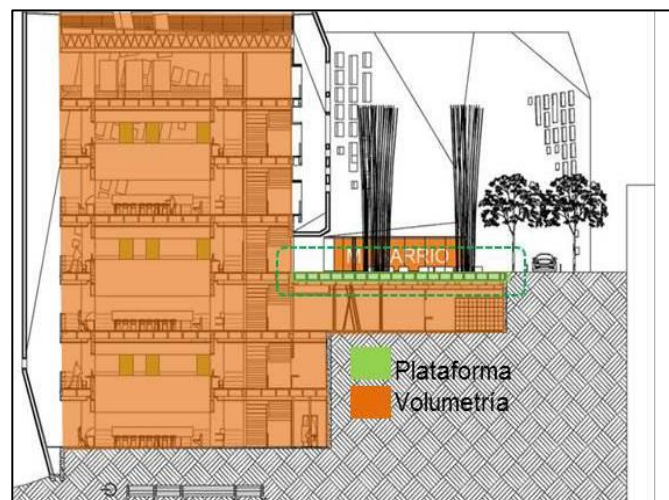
Sección longitudinal del Proyecto. (Fuente: www.plataformaarquitectura.com)
